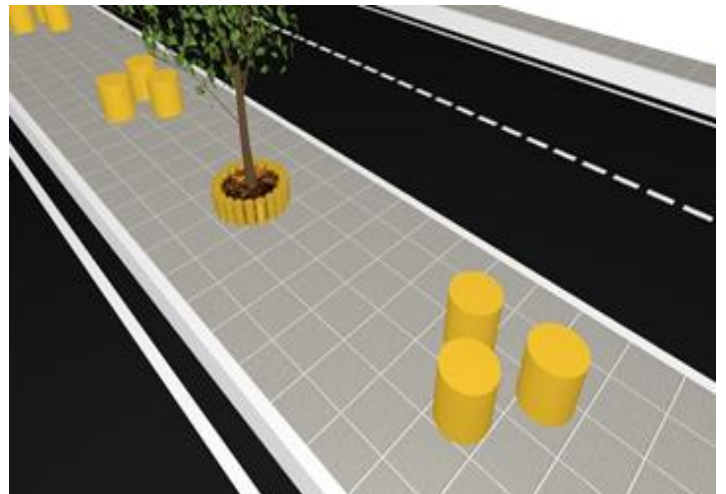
Canteiro central da Avenida Getúlio Vargas com as placas pré-moldadas de concreto com PET, vista em 3D.
